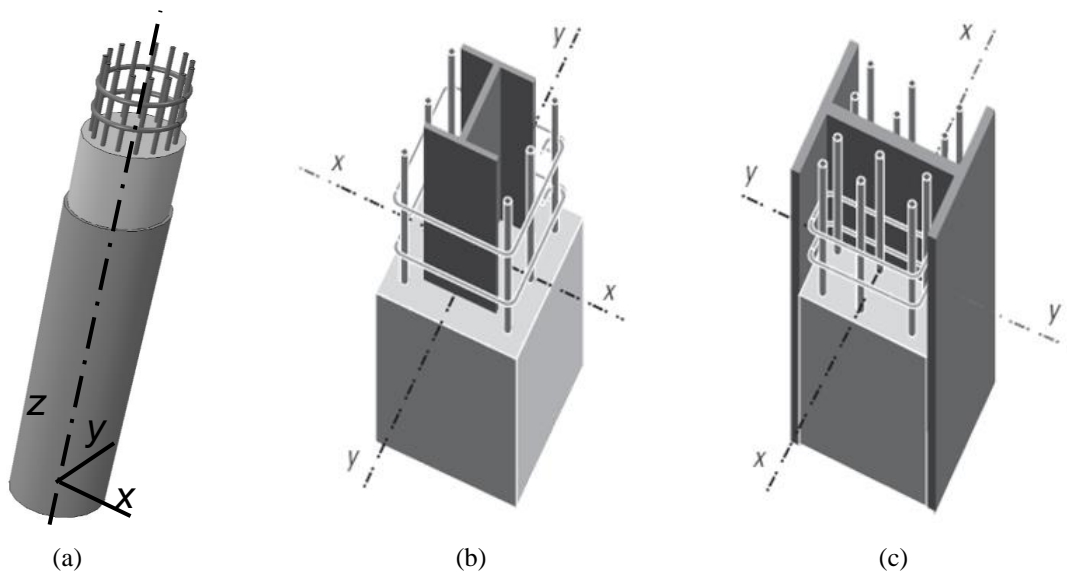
Exemplos de pilares mistos de aço e concreto: (a) pilar misto de seção tubular preenchido com concreto, (b) pilar misto com perfil I revestido com concreto (Fakury *et al.*, 2016), (c) pilar misto com perfil I parcialmente revestido com concreto (Fakury *et al.*, 2016).
